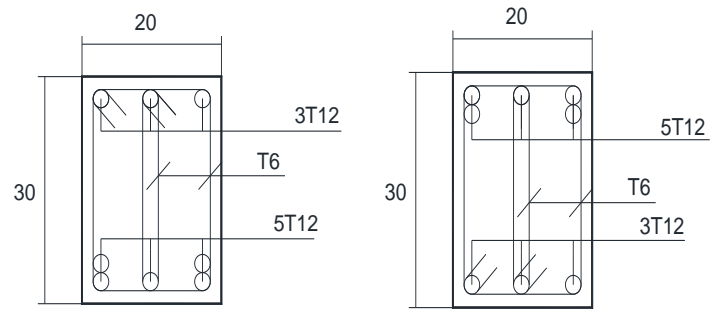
Coupe longitudinale d'une poutre secondaire 20x30cm (plan légèrement irrégulier)
